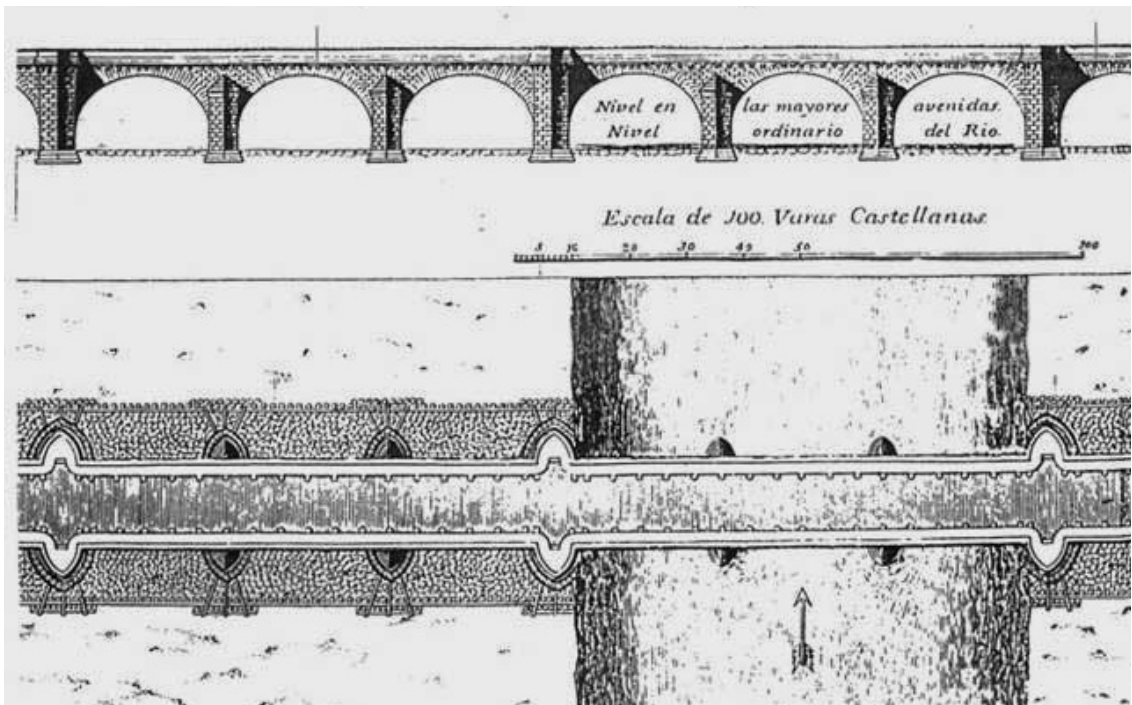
Detall de la planta i l'alçat del pont de Molins de Rei, publicat a la traducció espanyola del tractat de John Muller. 1769.
